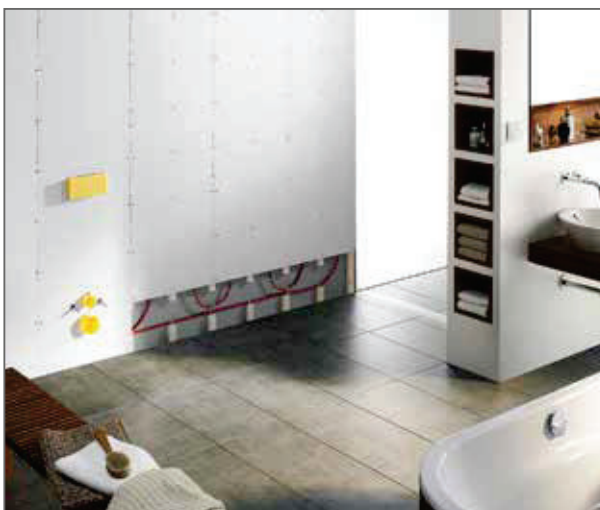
Einbausituation der Fonterra Side 12 Wandheizung
